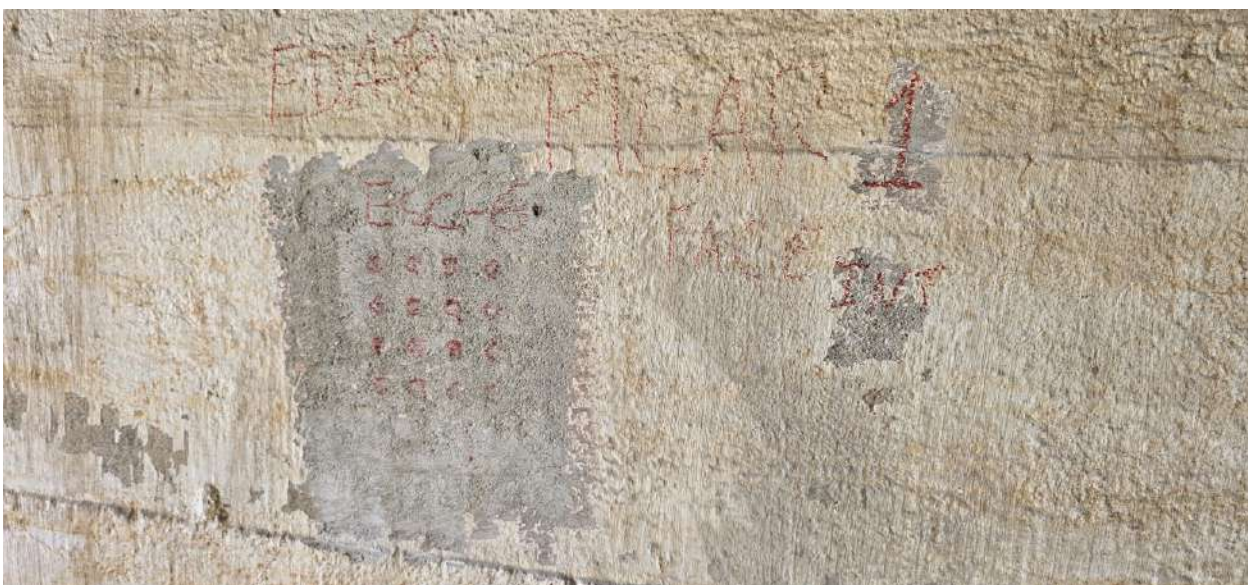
Ensaio de esclerometria ESC-6 no pilar P1 face vão P1 e P2
